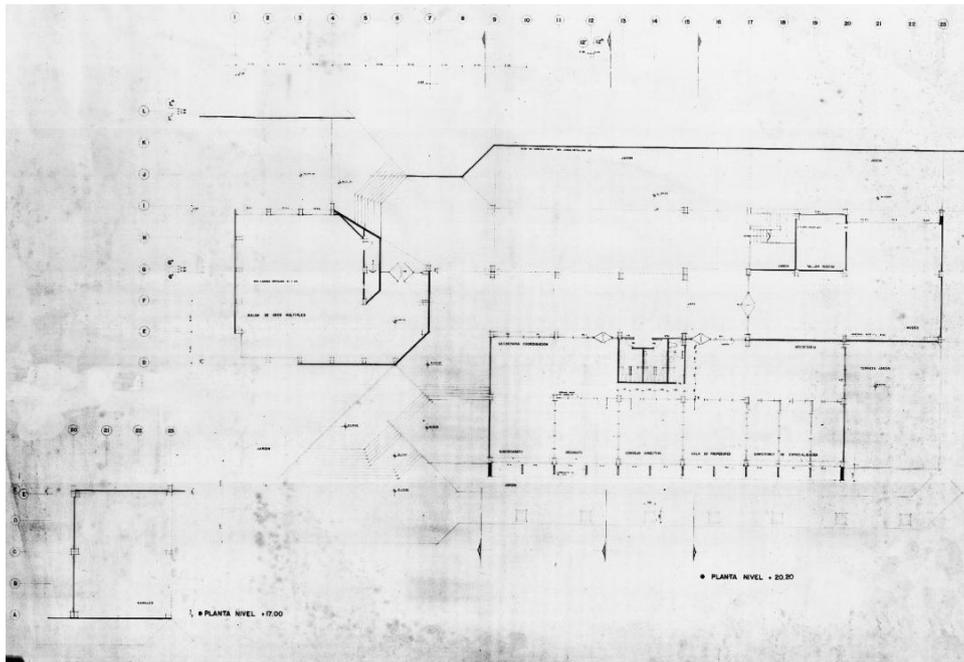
Planos de proyecto de Fac. Técnica UCSG
